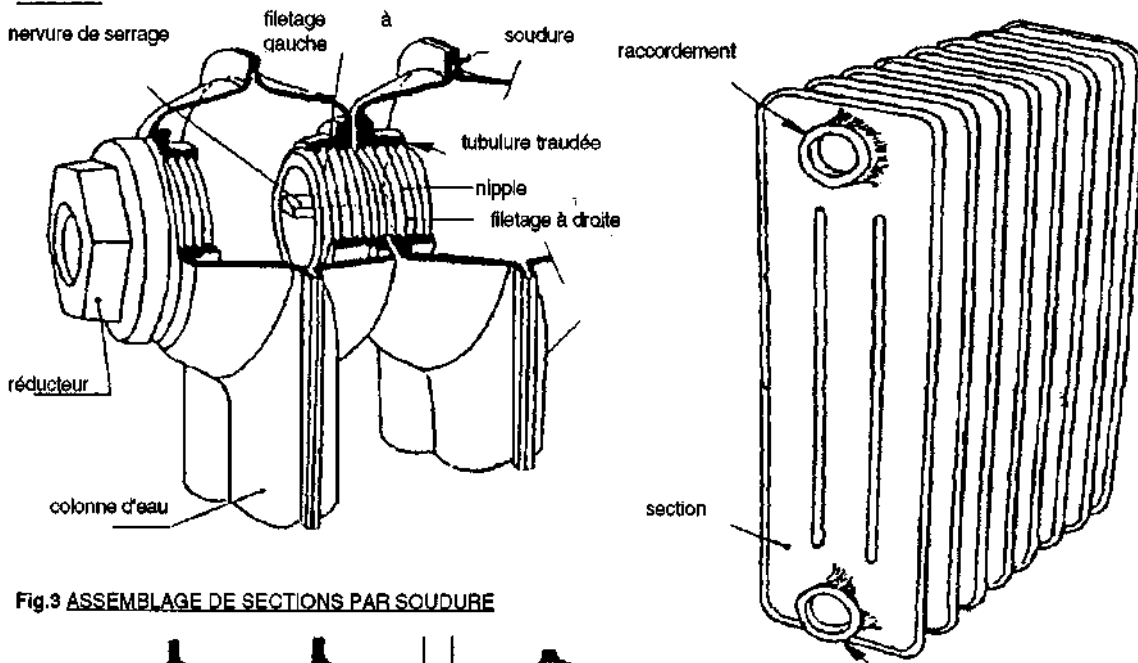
ASSEMBLAGE DE SECTIONS PAR SOUDURE
